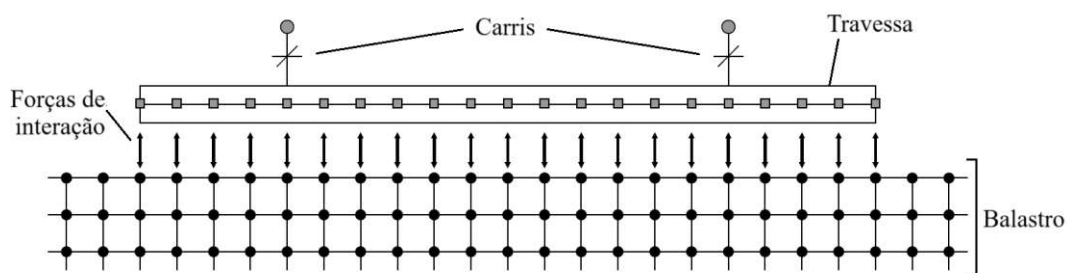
Forças de interação travessa-balastro na direção longitudinal da travessa
